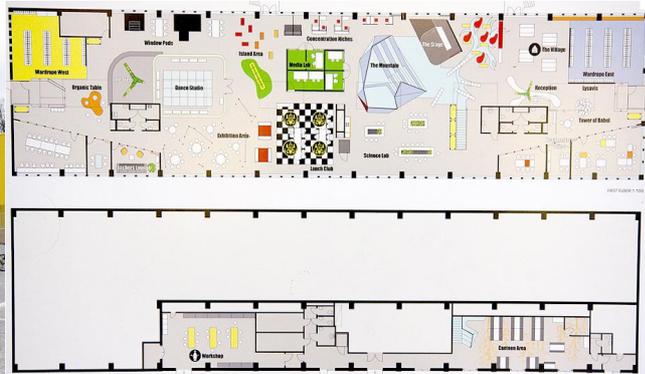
Pianta piano terra “Quando lo spazio insegna”, Indire
